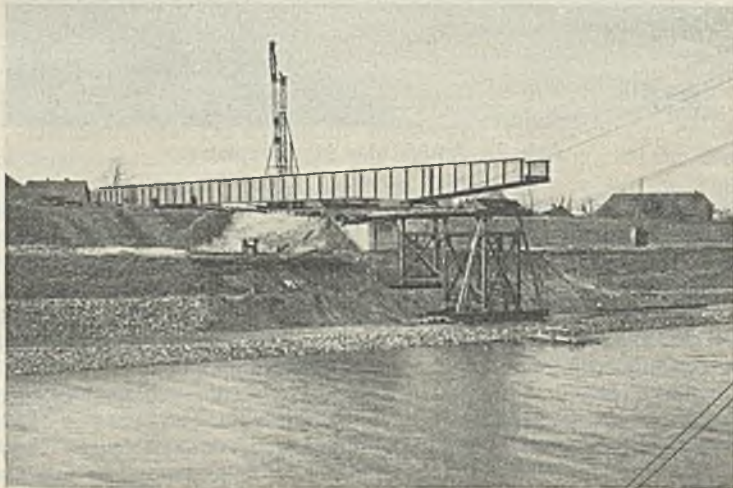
Die Brücke wird vom Montageplatz auf das Joch gefahren.
